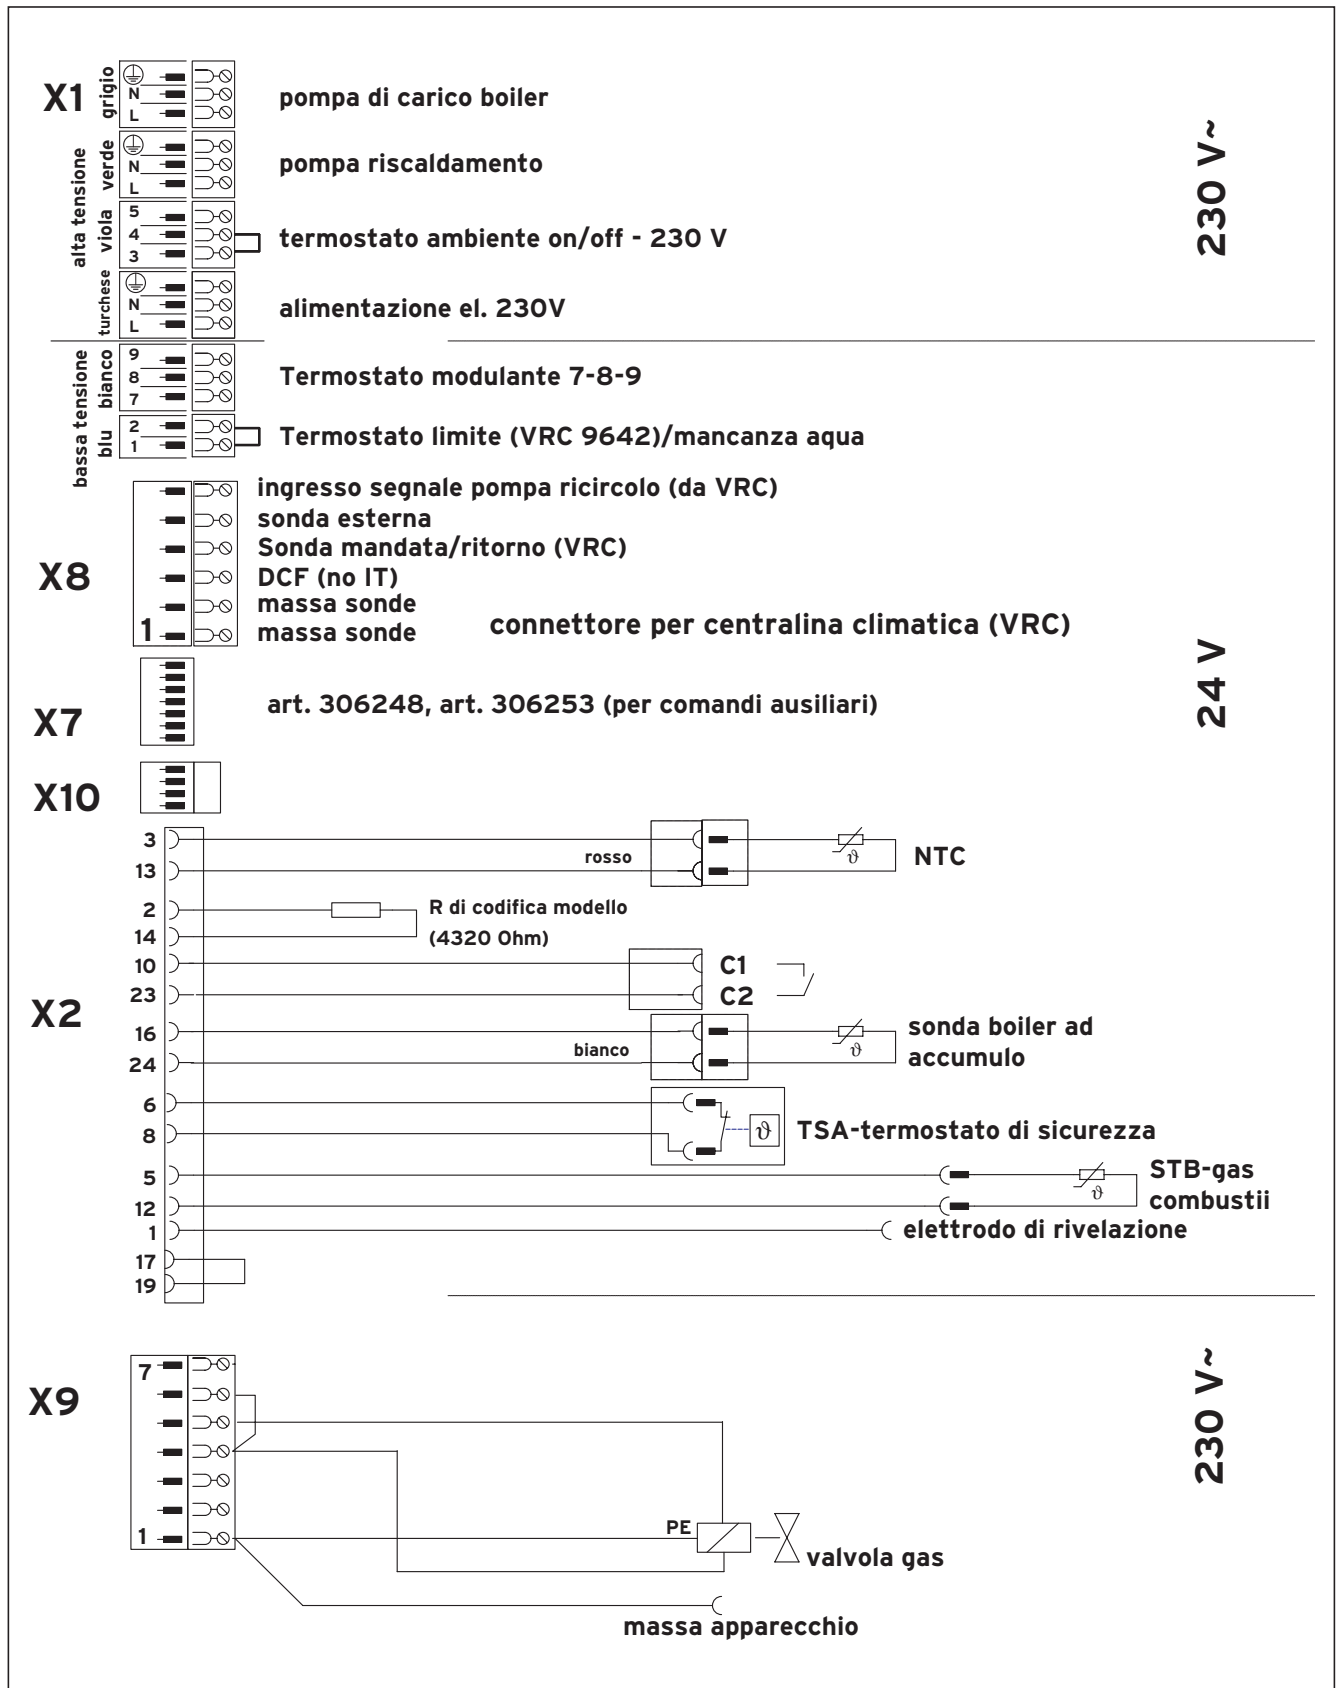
Collegamenti elettrici dell'atmoVIT
